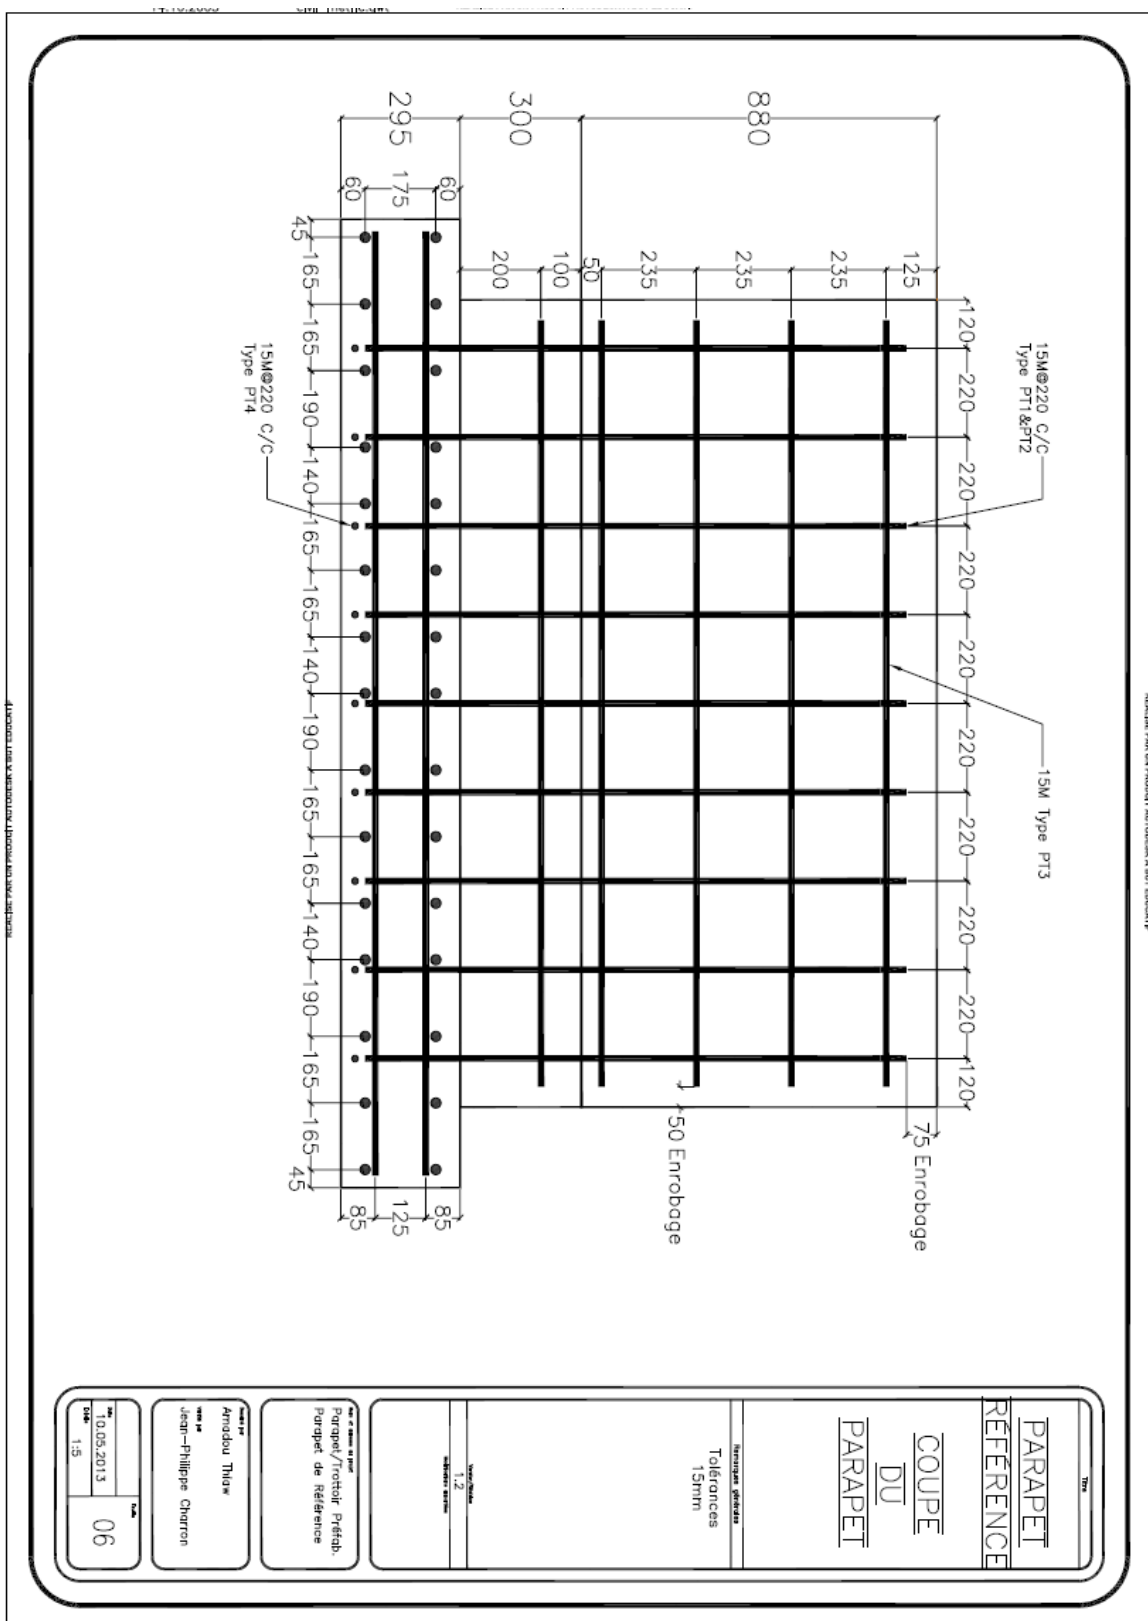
Coupe du parapet de référence et détails du trottoir
